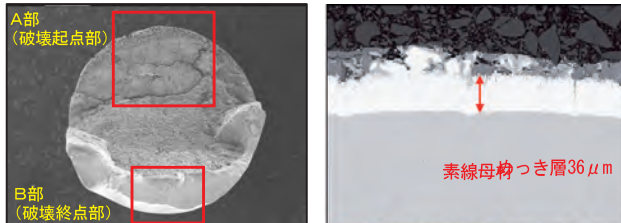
素線破断面観察 (格点 63) 写真-21 亜鉛めっき厚
